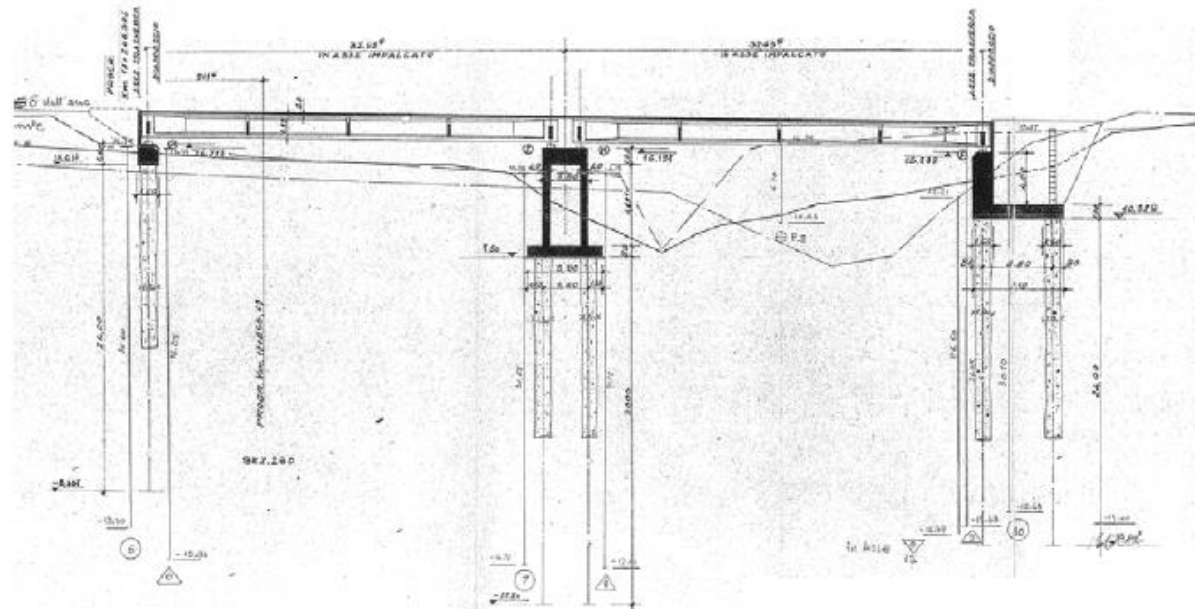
Viadotto Cacchione – Profilo longitudinale Carreggiata Sud
